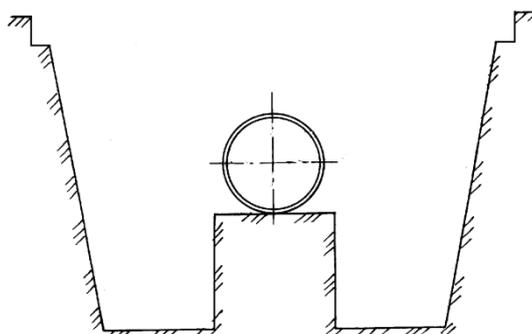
Подготовленный приямок для установки подкапывающей машины
